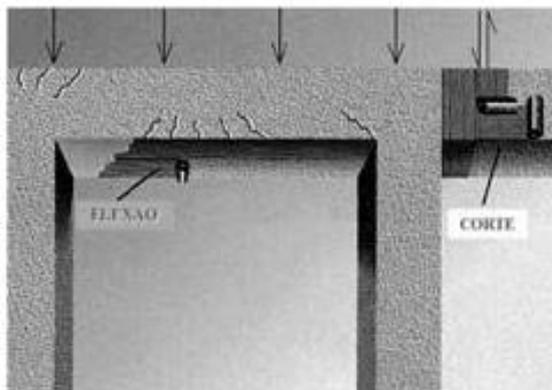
Reforço de vigas à flexão e ao corte.
